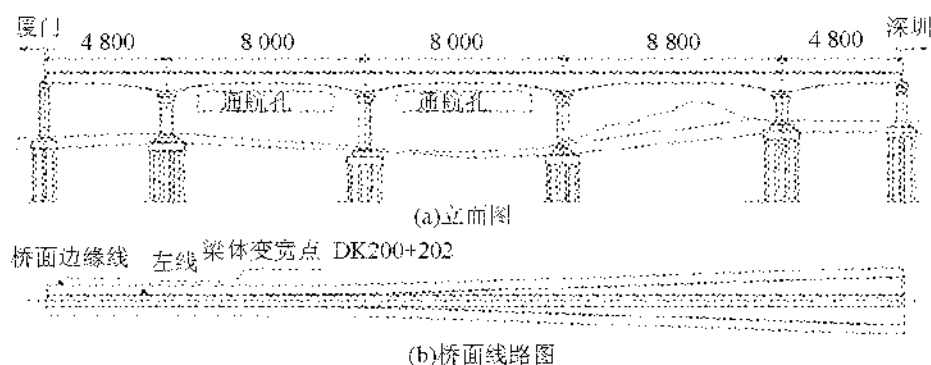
韩江桥道岔段连续梁立面和桥上平面线路布置(单位:cm)
